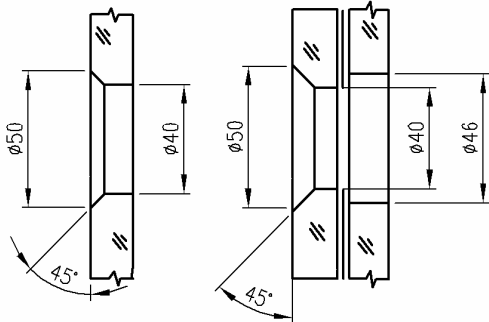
Façade VEA – Contreplaqué striée – Montage attache sans goupille – Plan de détail
